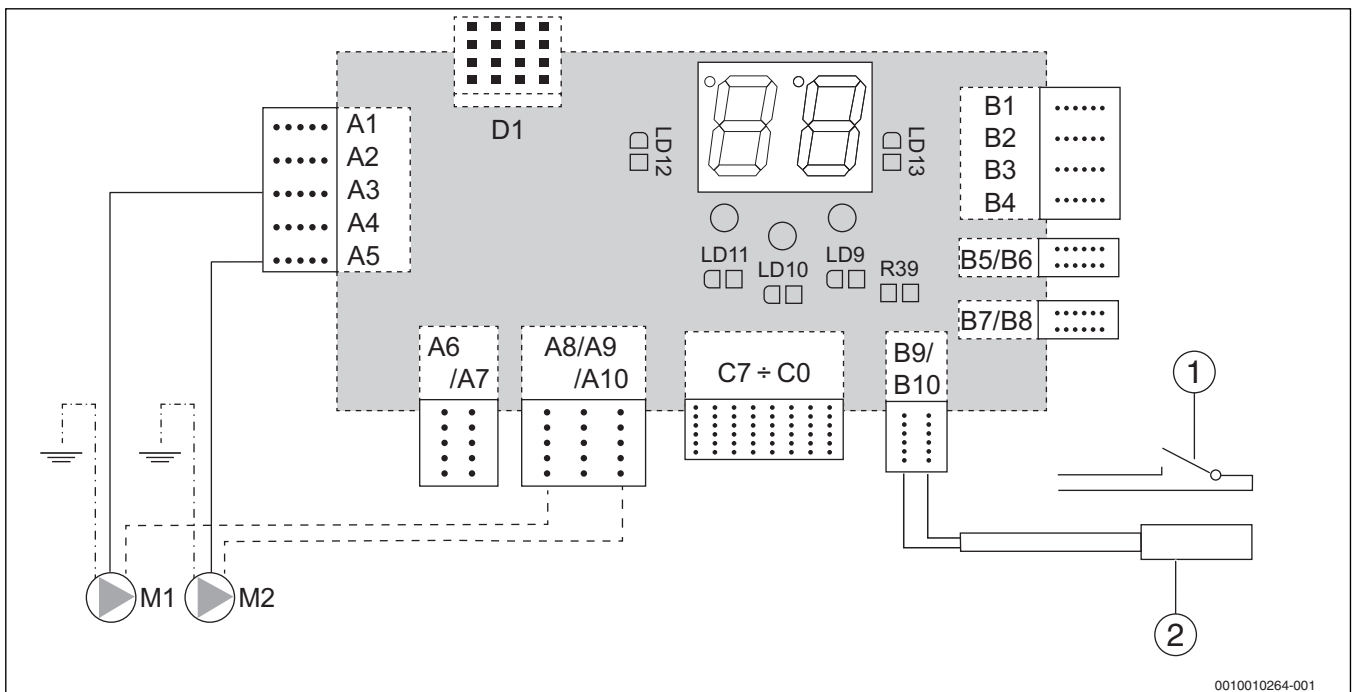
Steuerung der Aufheizung des Warmwassers (WW) durch zwei Pumpen (mit Rückschlagventil)
